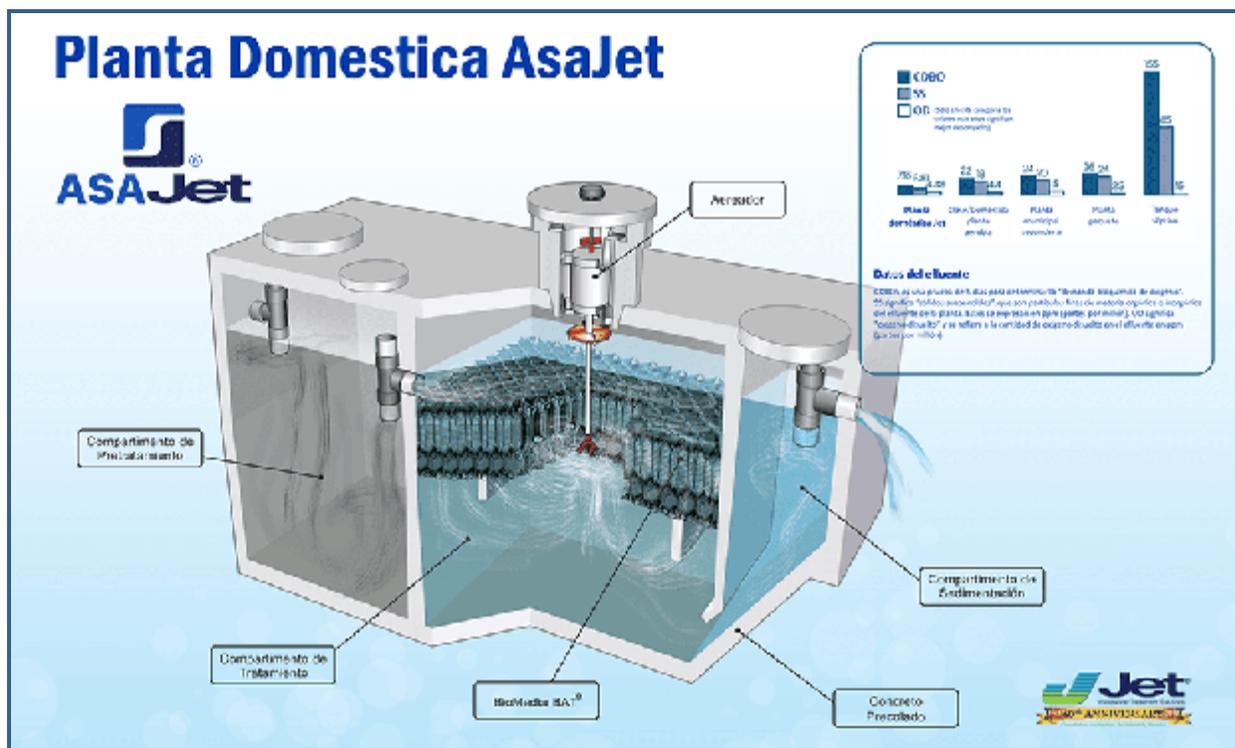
PLANTA DE TRATAMIENTO RESIDENCIAL ASAJET
